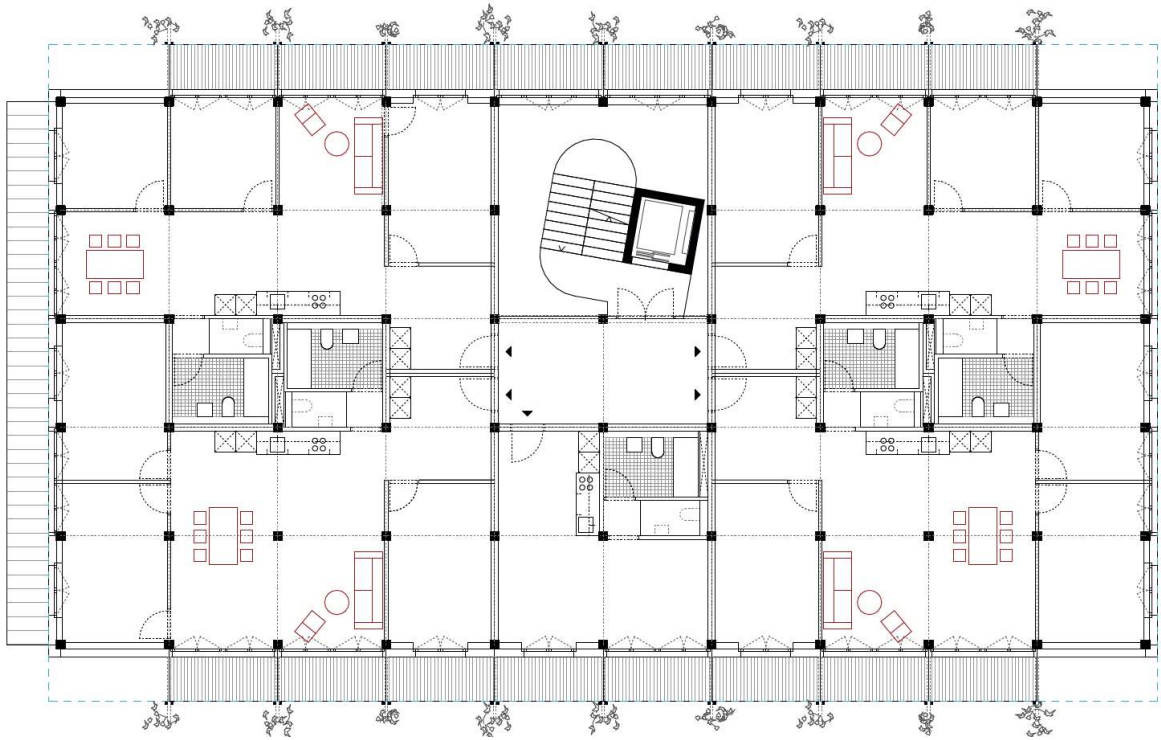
Grundriss Regelgeschoss, ohne Masstab
